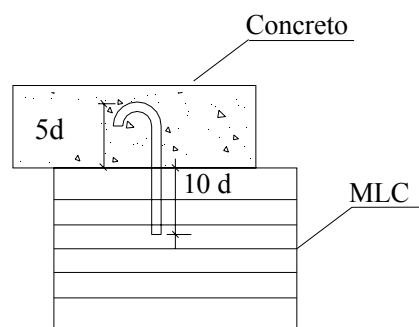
26 – Ancoragem do conector na laje mista de concreto e MLC
